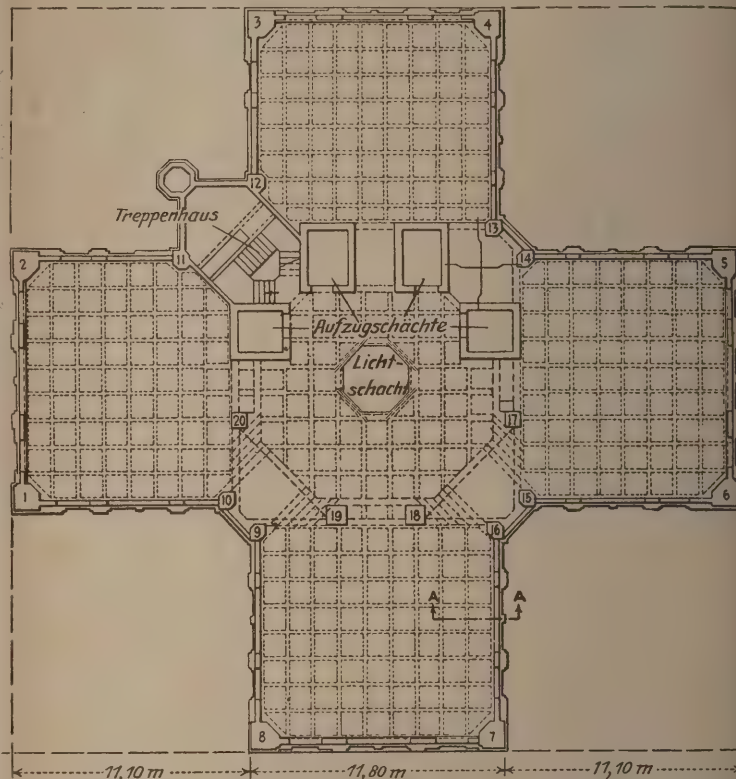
Grundriß des Gebäudes (über dem 3. Stockwerk).
